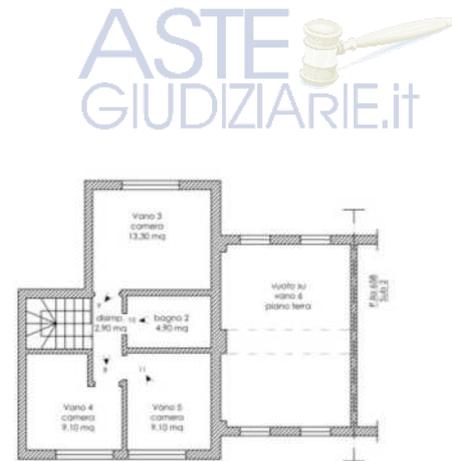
Schema planimetrico piano 1 come da allegato 8b alla presente relazione.
